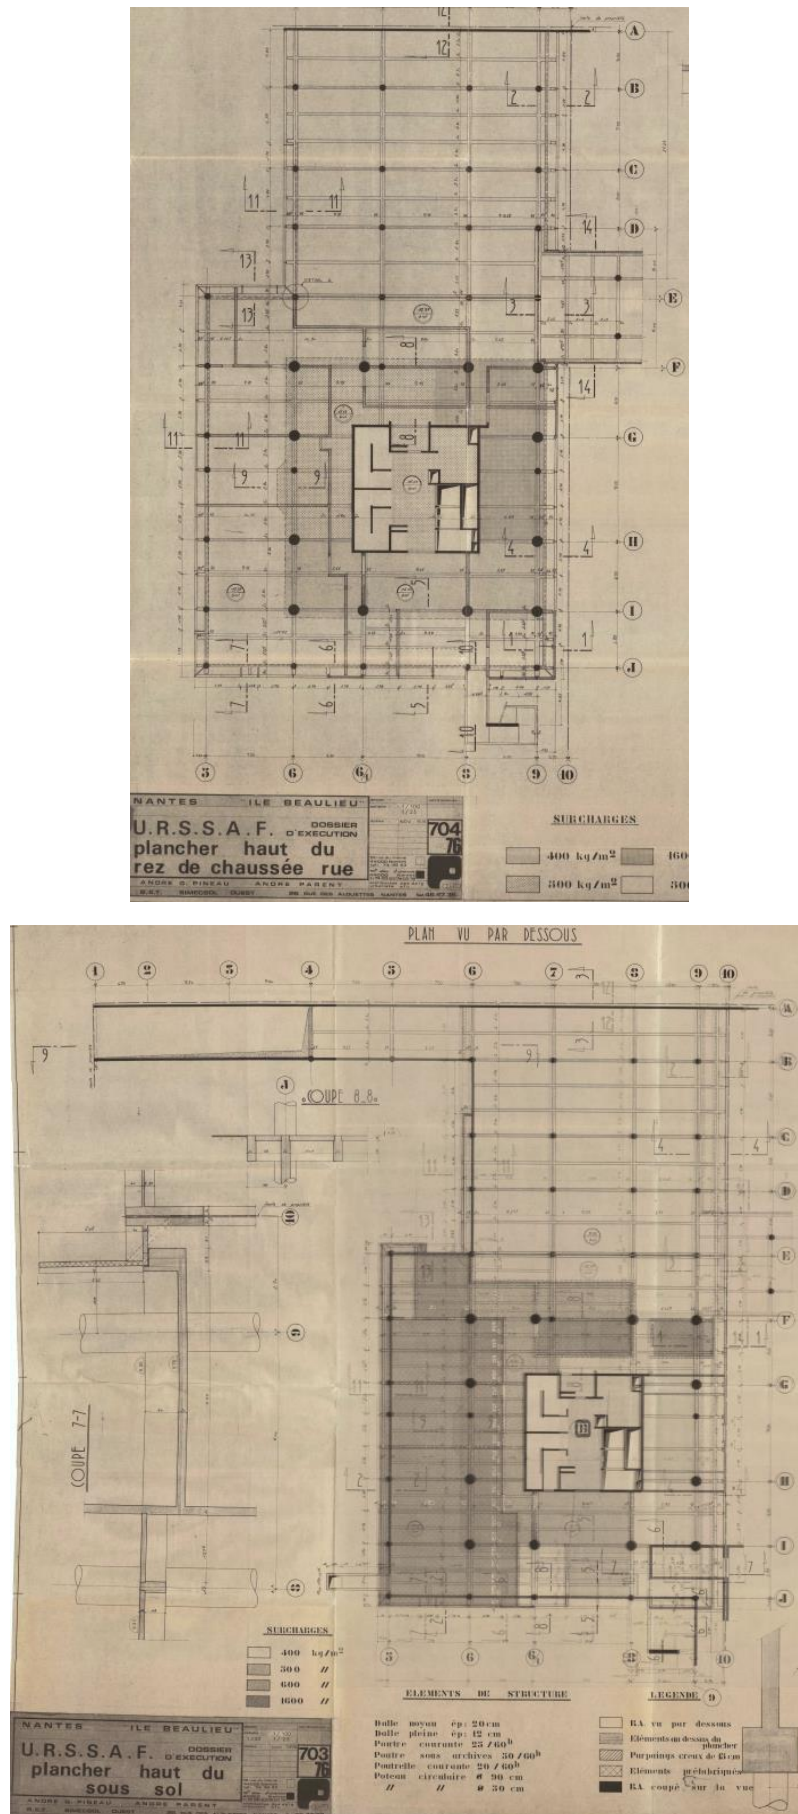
Plans d'exécution des planchers hauts RDC et sous-sol
